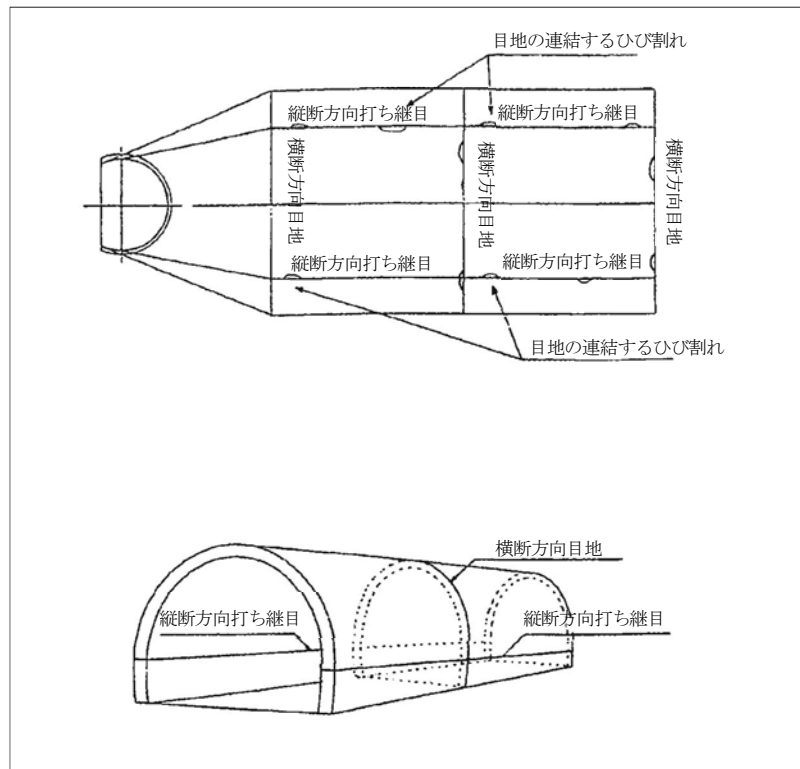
覆工コンクリートの目地と継目付近のひび割れ
